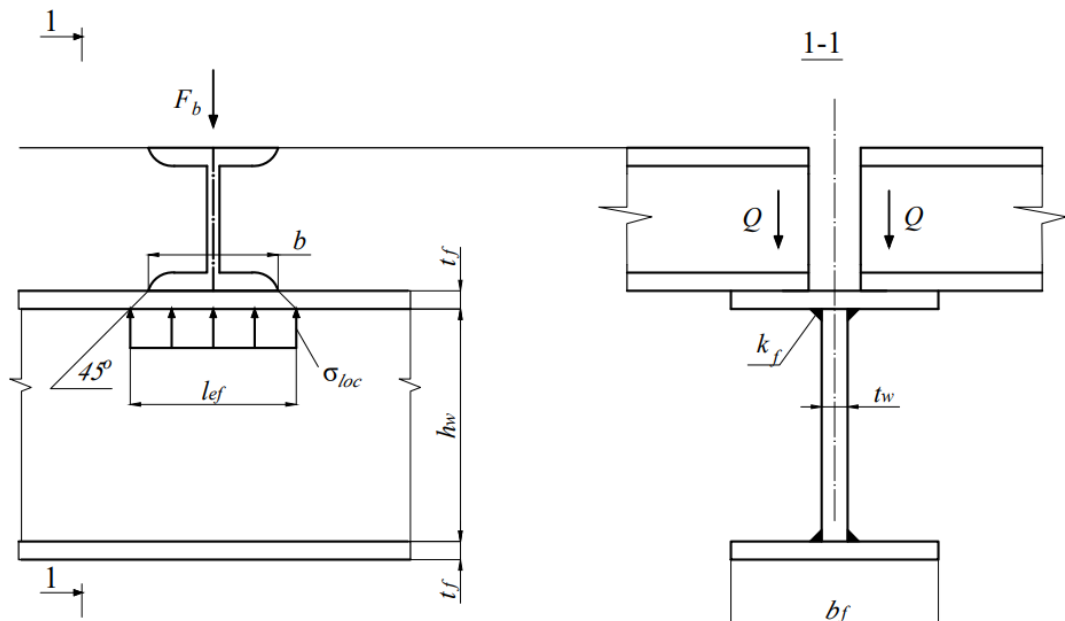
Схема розподілу зосередженого навантаження на стінку зварної балки при поверховому сполученні балок
